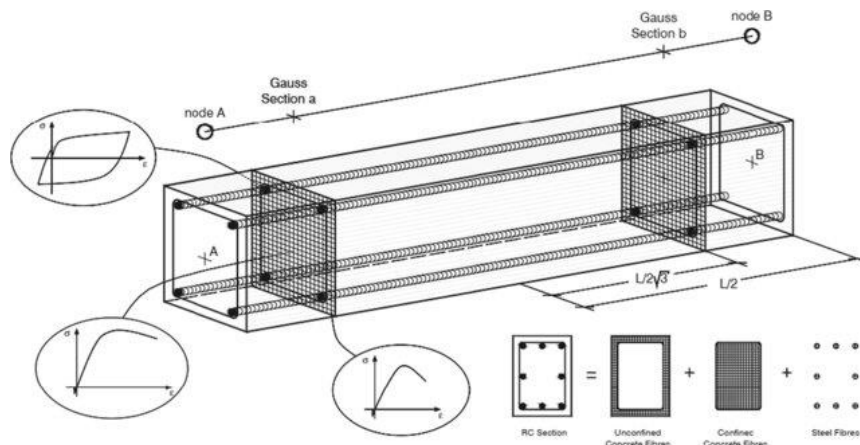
Elemento trave-colonna in fibra, discretizzazione della sezione tipica del calcestruzzo [37]
